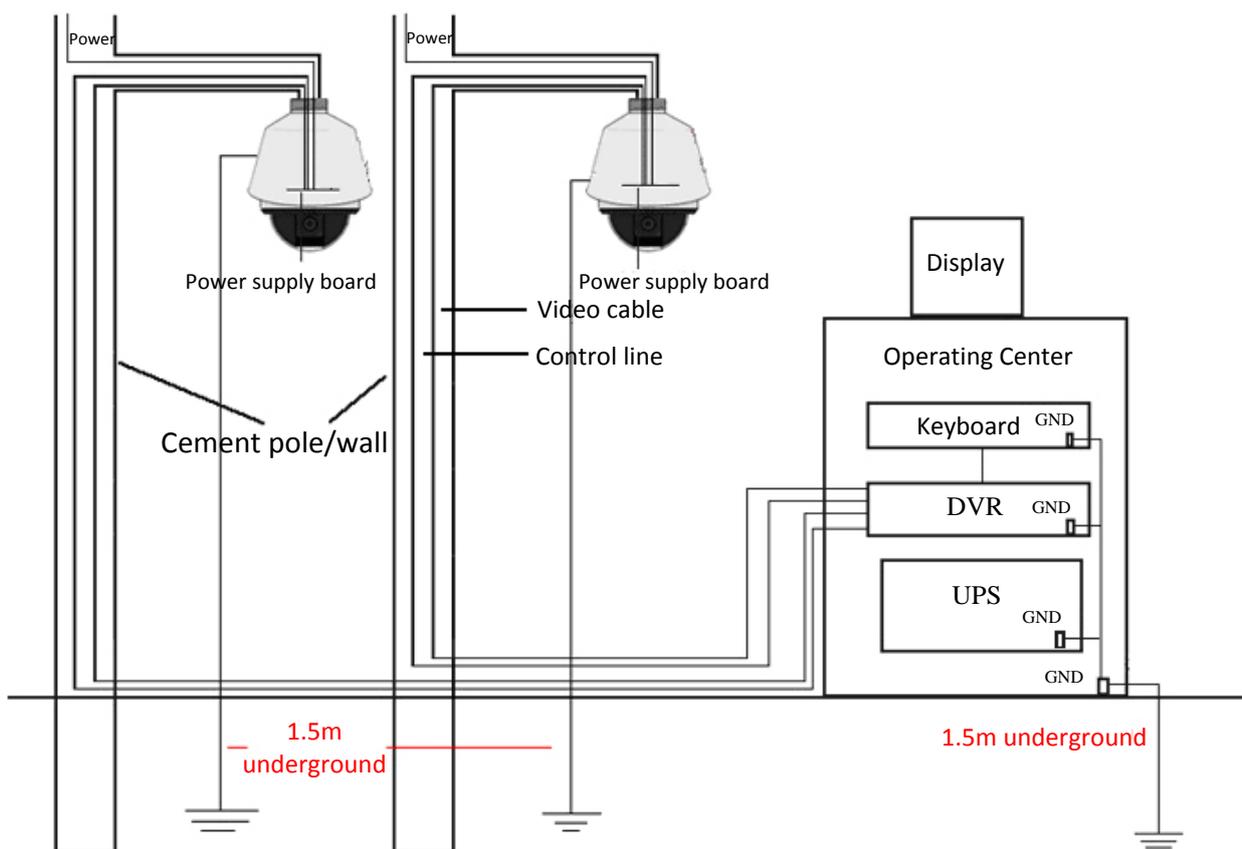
Protection contre la foudre par mise à la terre d'une installation sur poteau ou mur en ciment
